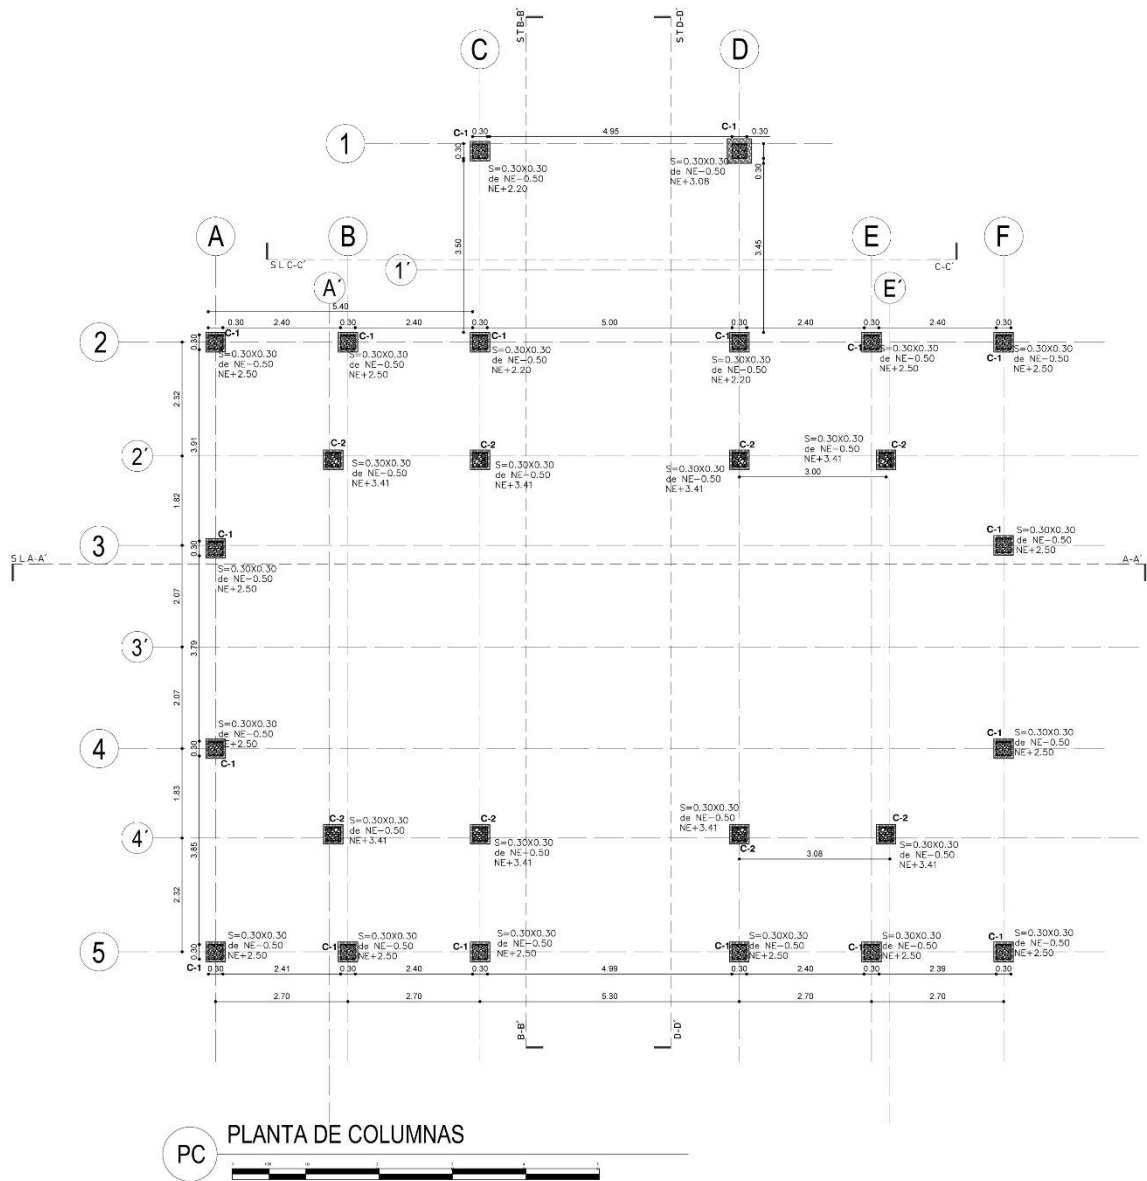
Plano estructural propuesta de la vivienda indígena Sàliba
